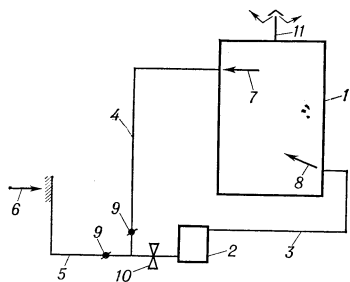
Схема воздушного отопления, совмещённого с вентиляцией: 1 — отапливаемое помещение; 2 — воздухоподогреватель; 3 — воздухопровод, подающий горячий воздух в отапливаемое помещение; 4 — воздухопровод, подающий рециркуляционный воздух к воздухоподогревателю; 5 — воздухопровод, подающий наружный воздух к воздухоподогревателю; 6 — воздухозаборная решётка наружного воздуха; 7 — воздухозаборная решётка рециркуляционного воздуха; 8 — воздухоподающая решётка; 9 — дроссели клапана; 10 — вентилятор; 11 — вытяжная вентиляция.
